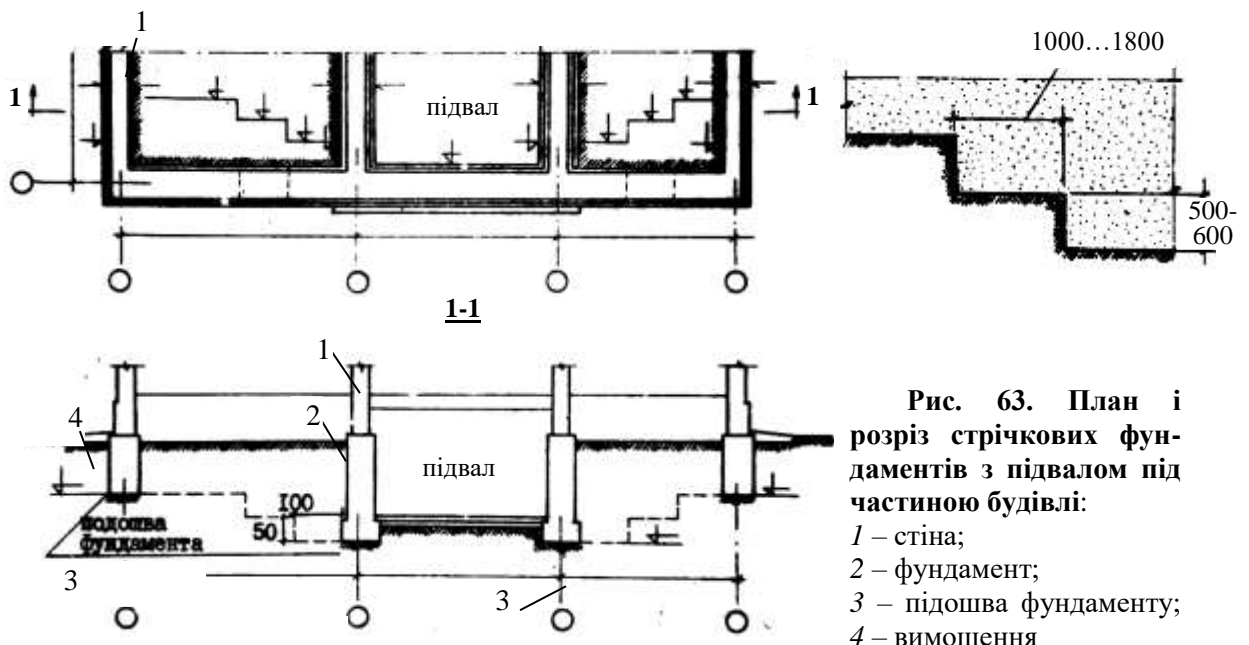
План і розріз стрічкових фундаментів з підвалом під частиною будівлі:
